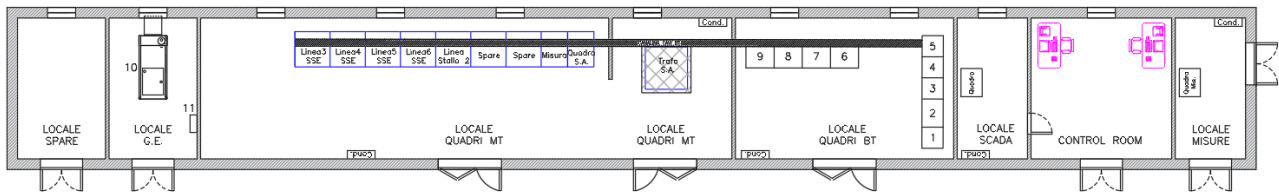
Stazione Elettrica Utente Stallo 2 – Planimetria
